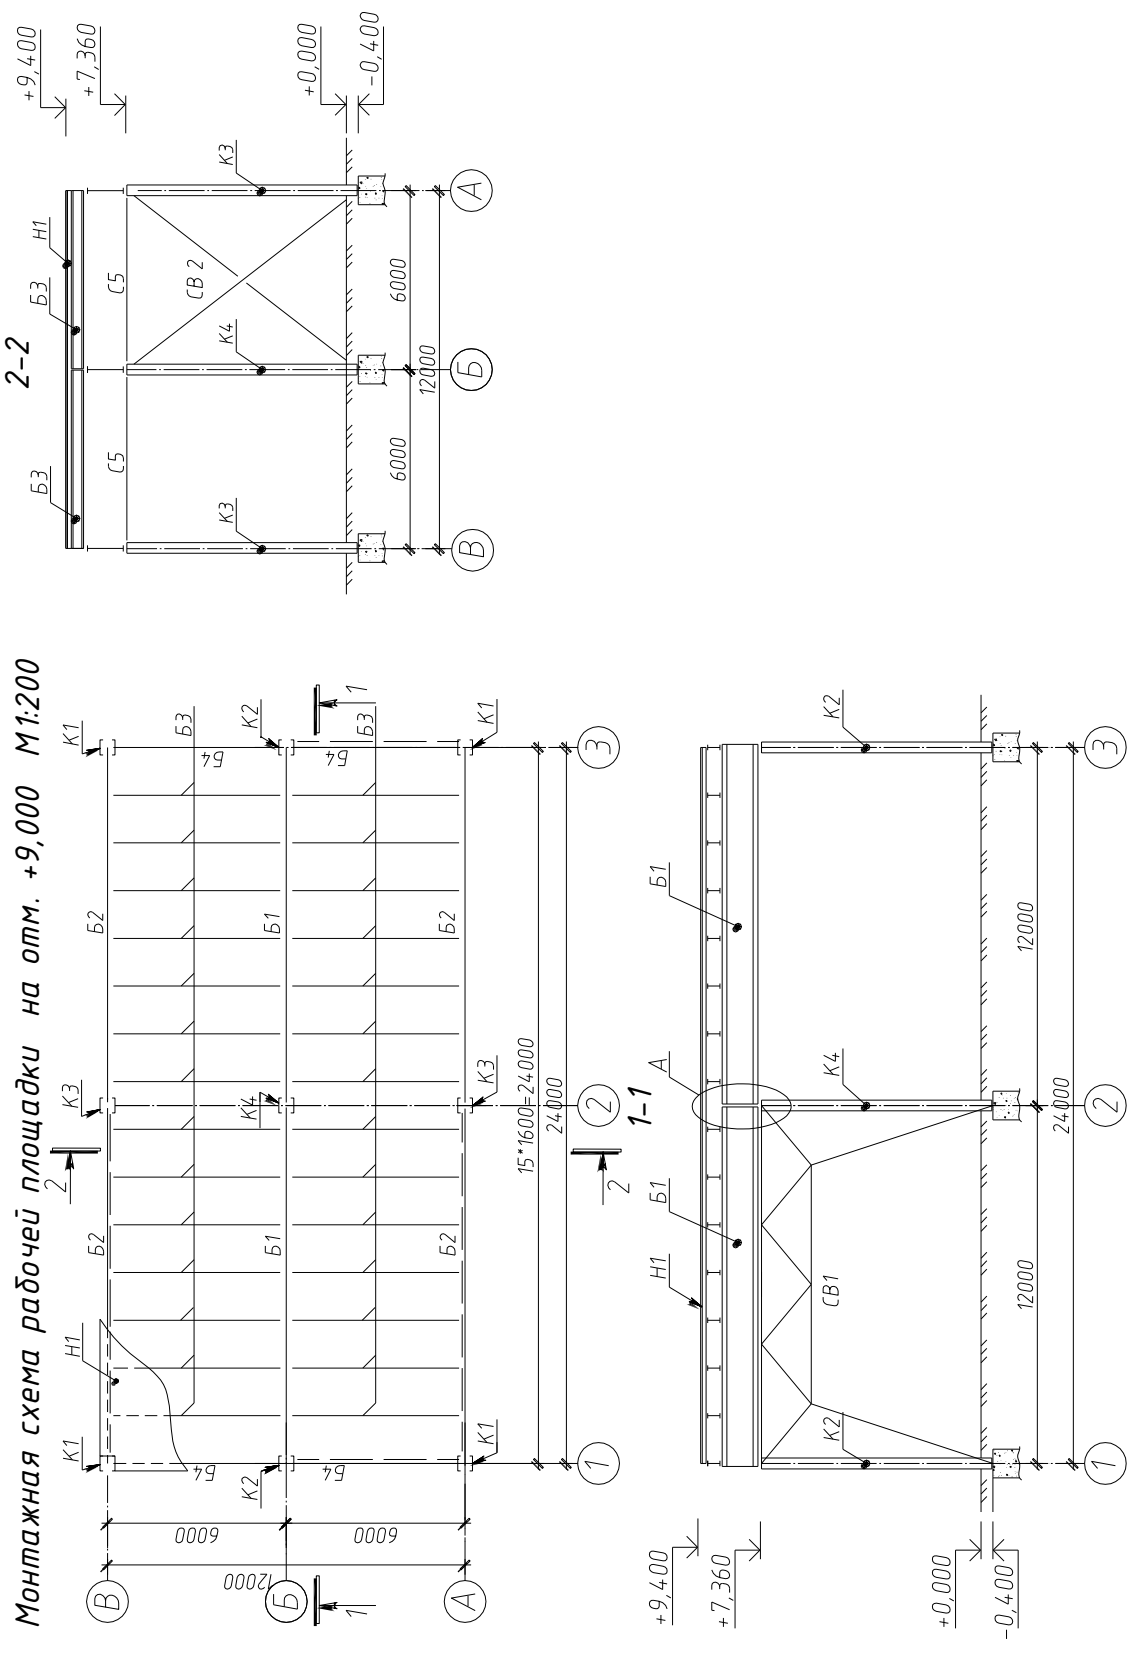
Монтажная схема рабочей площадки на отм. +9,000
